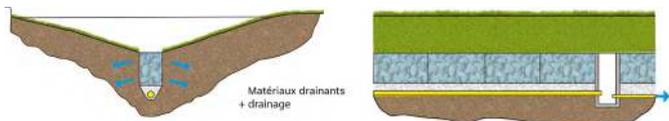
schéma d'une coupe en travers et coupe en long de noue drainée
